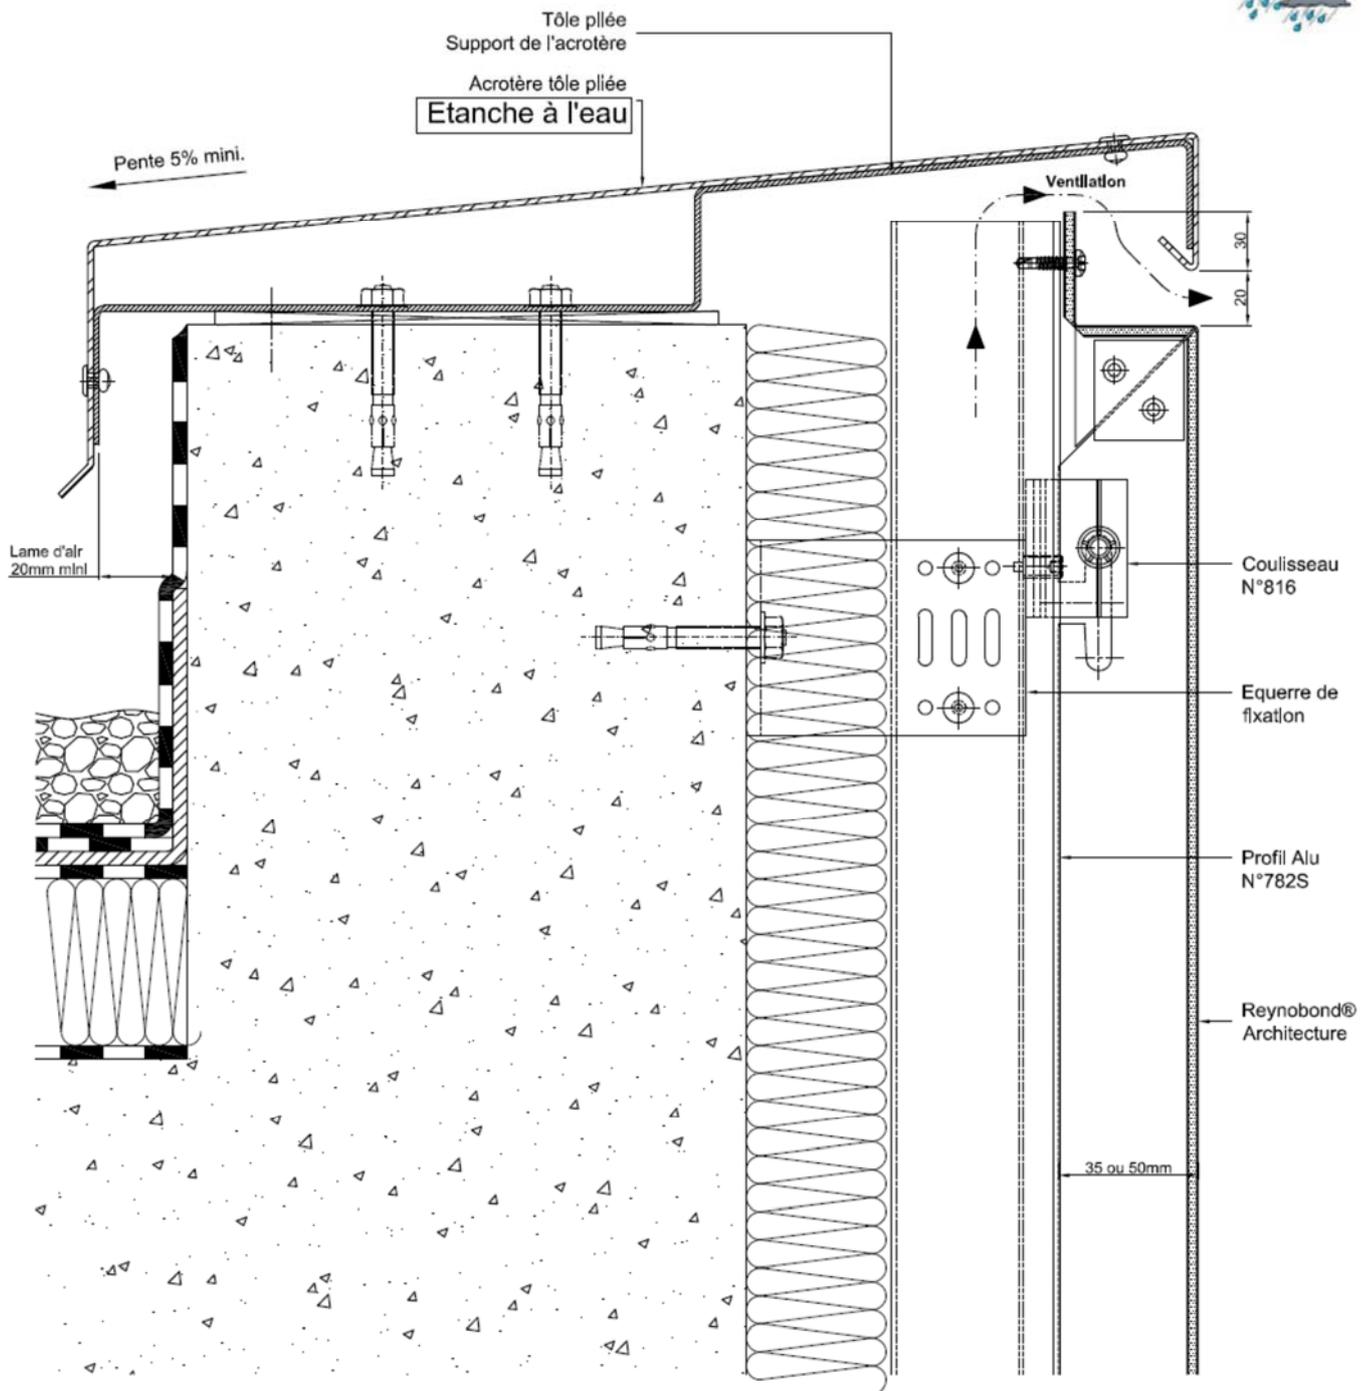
Détail haut de bardage – Coupe verticale KU 50 VA
